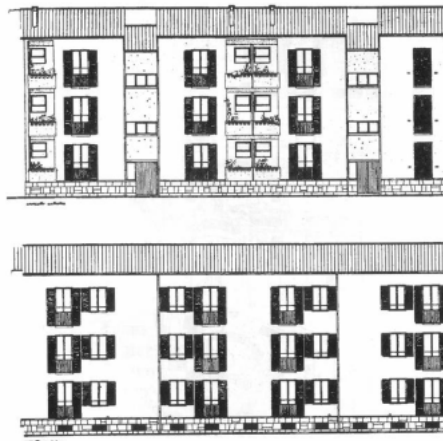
Prospetto tipo, tratti da “Piano incremento occupazione operaia. Case per lavoratori. Suggerimenti, esempi e norme per la progettazione urbanistica : progetti tipo Roma, 1950
